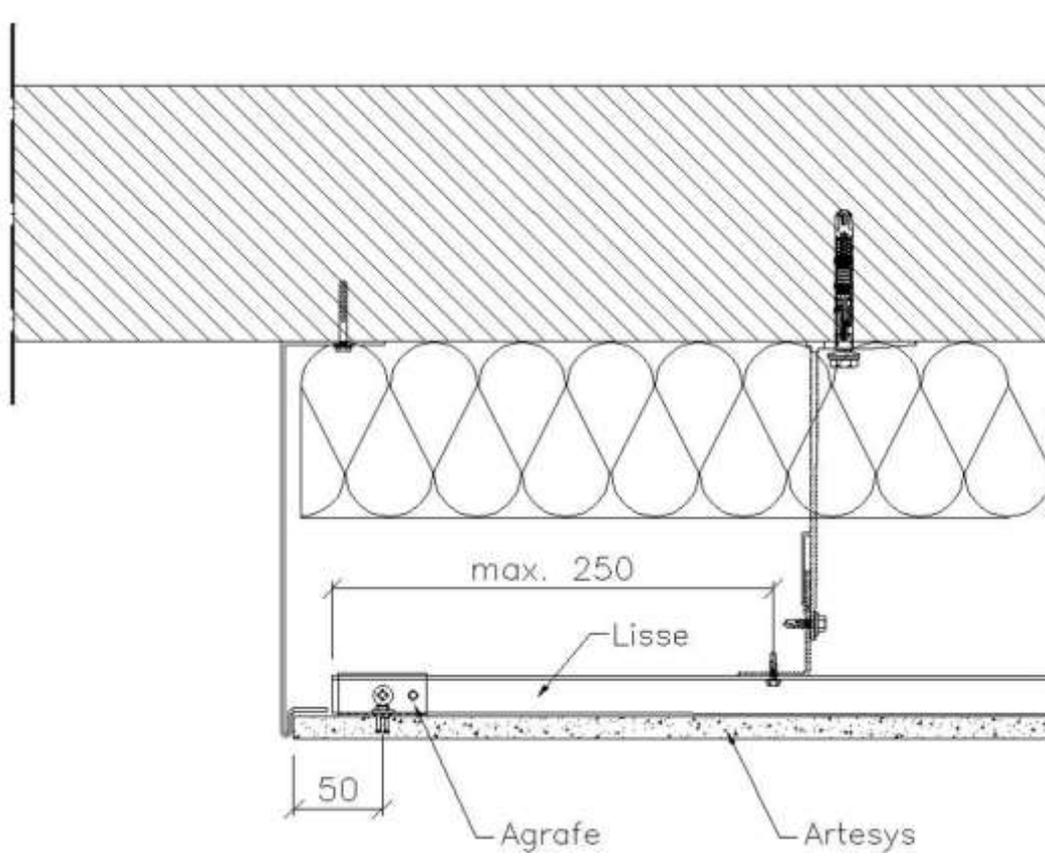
Arrêt latéral (plaque indépendante fixée sur rail)
